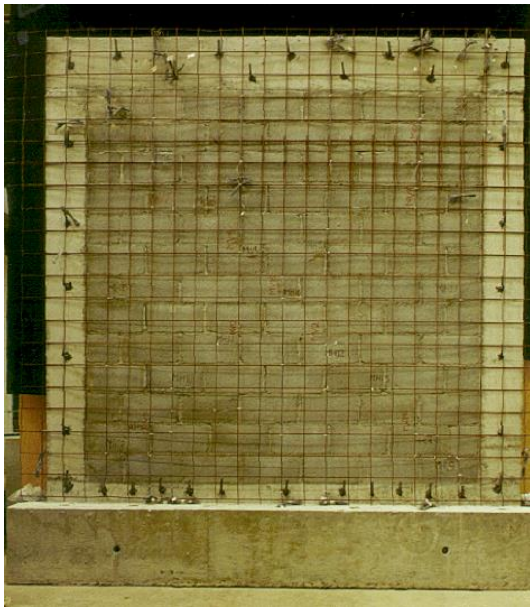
Muro con malla metálica y anclajes distribuidos en el marco de concreto (Flores, 2003).
